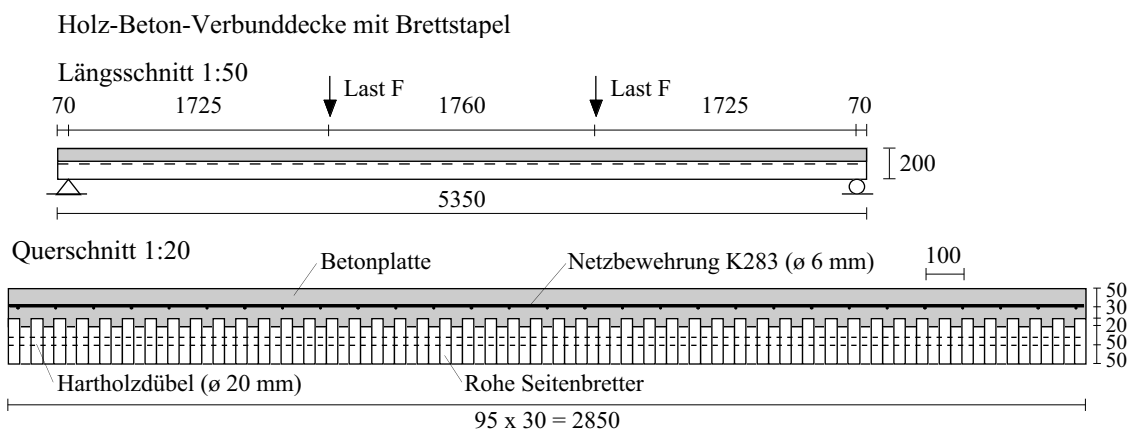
Holz-Beton-Verbunddecke mit Brettstapel
